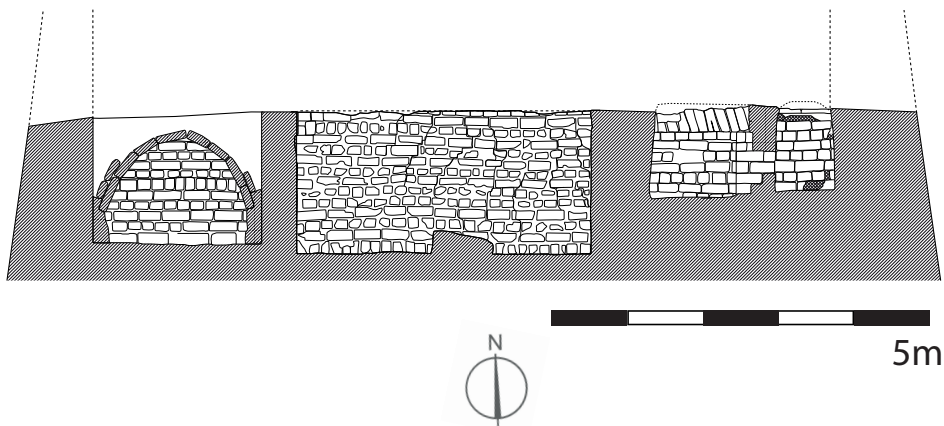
Coupe de la maison-tour TG2012.K6 (plan préliminaire)
